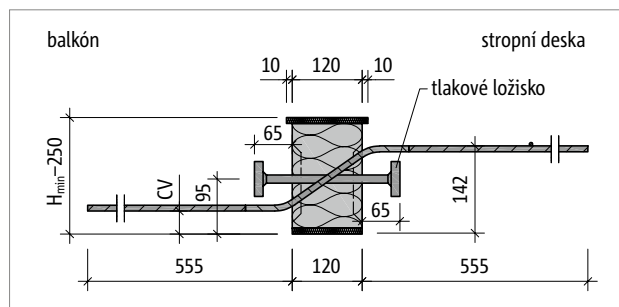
Schöck Isokorb® XT typ QP-VV: Statický systém
